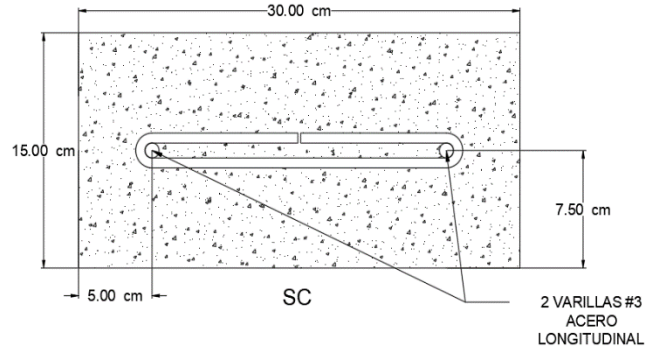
Acero de Refuerzo Longitudinal -SC- Modelo III
